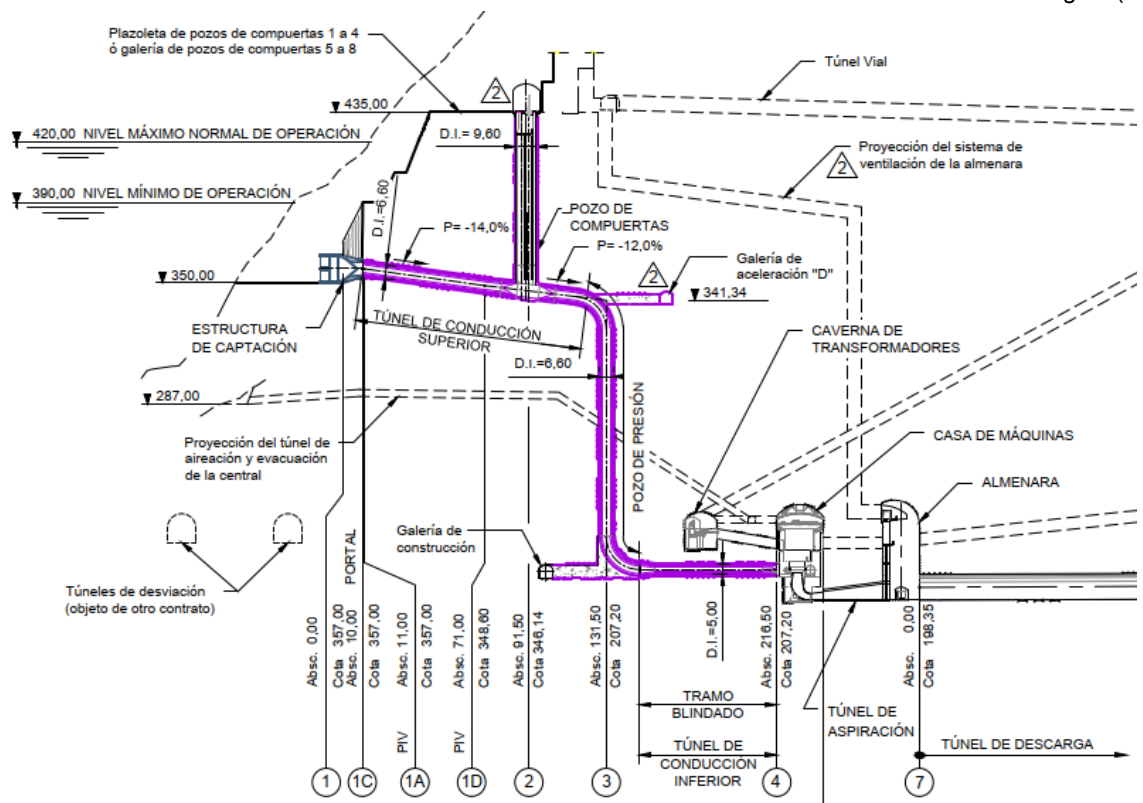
Perfil longitudinal de la captación, conducción y pozo de presión hasta la caverna de máquinas (plano D-PHI-050-CND-GE-C-020) (Integral, 2020a)
